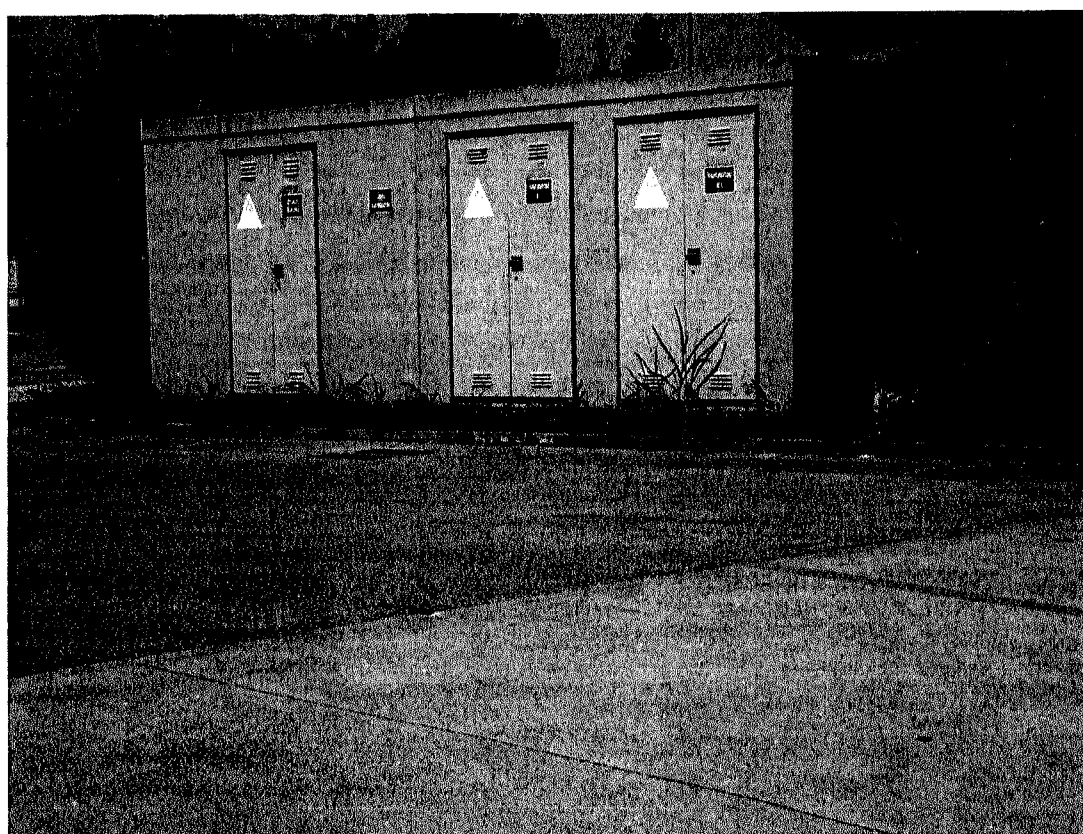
vista del locale contatori poste sul lato ovest del lotto
